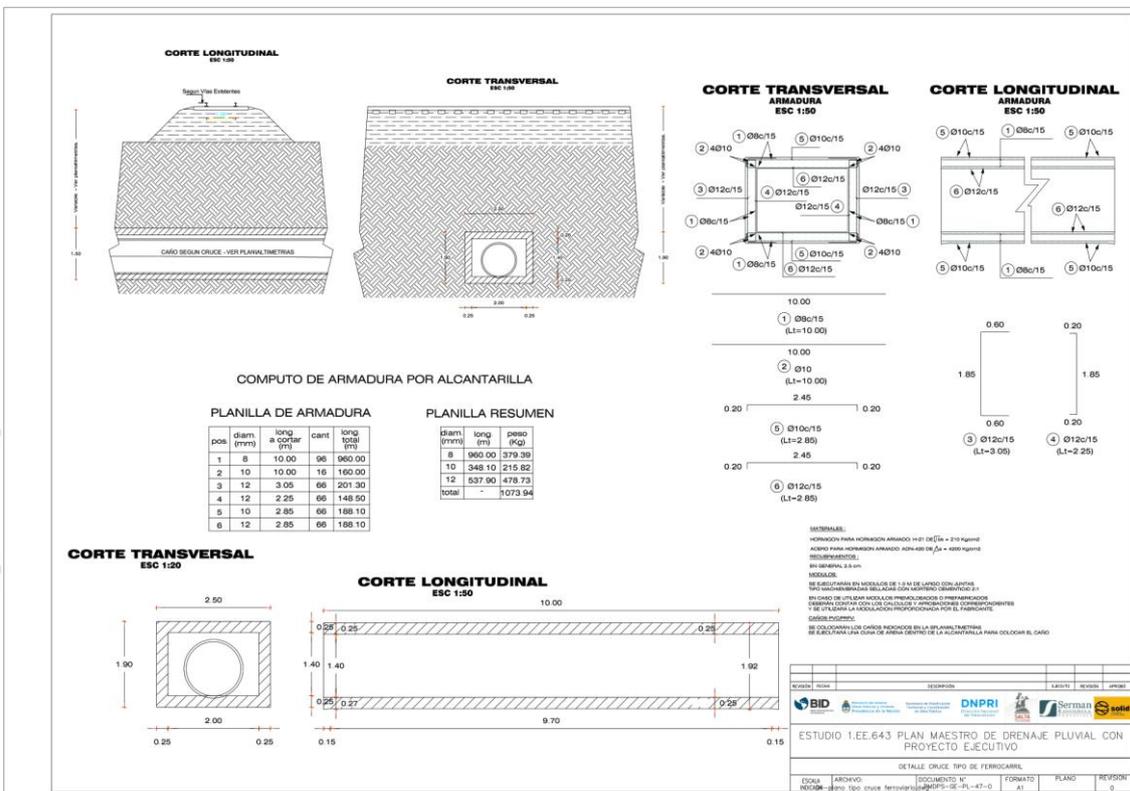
Plan Maestro de drenaje Pluvial – Canal Alvear
